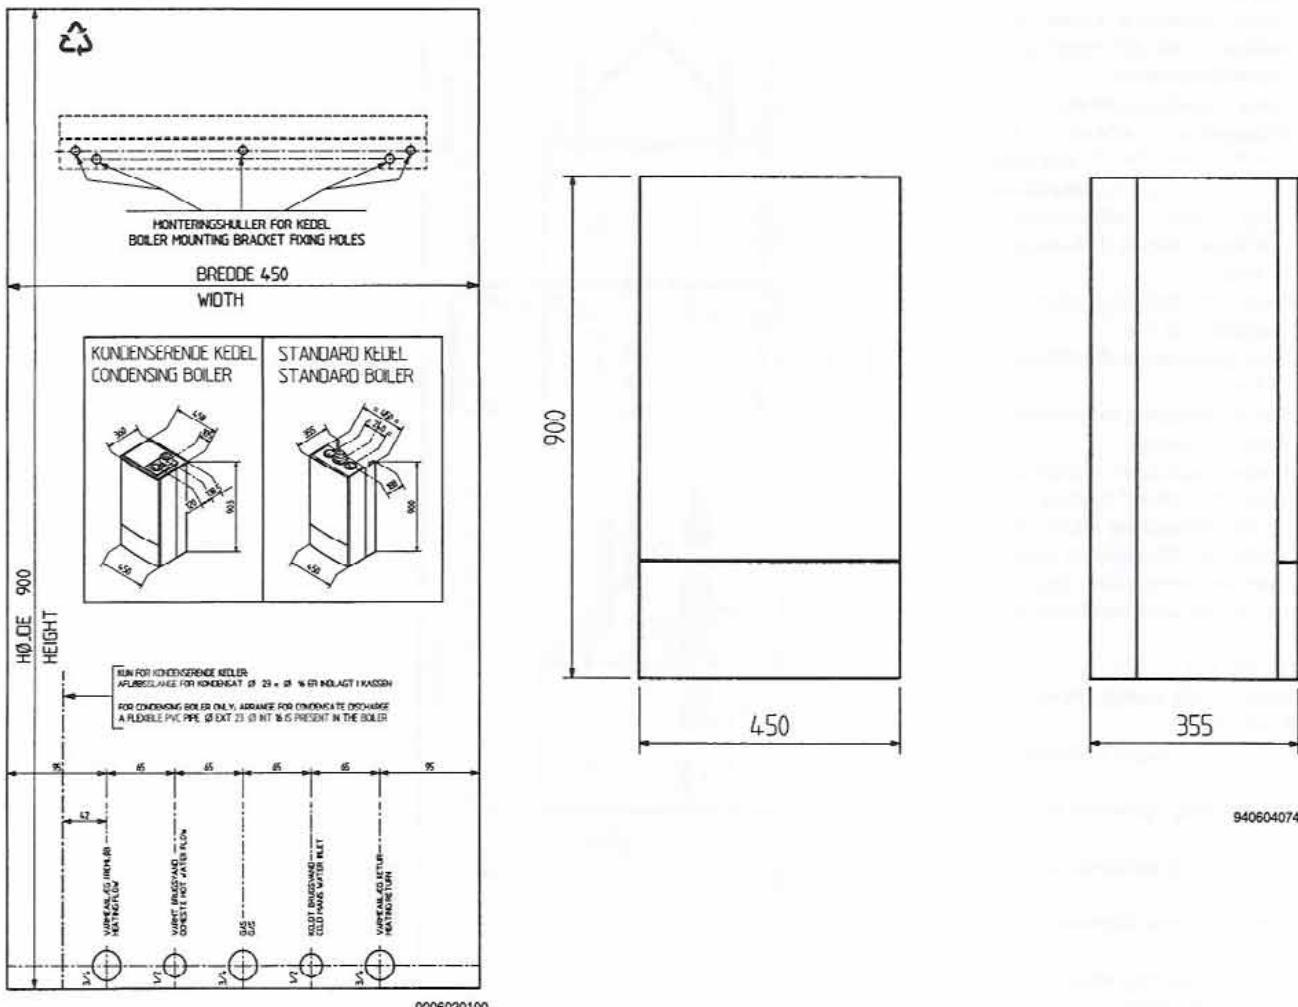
Målskitse for kedel. - Dimensioned drawing for boiler.
